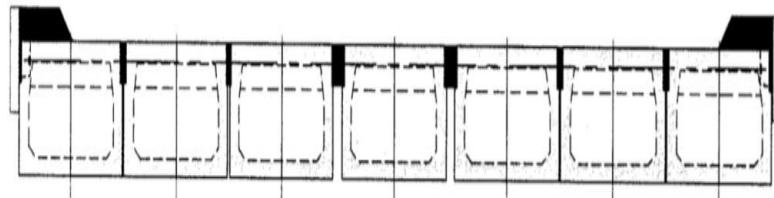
Poutres en U préfabriquées avec dalle coulée en place
